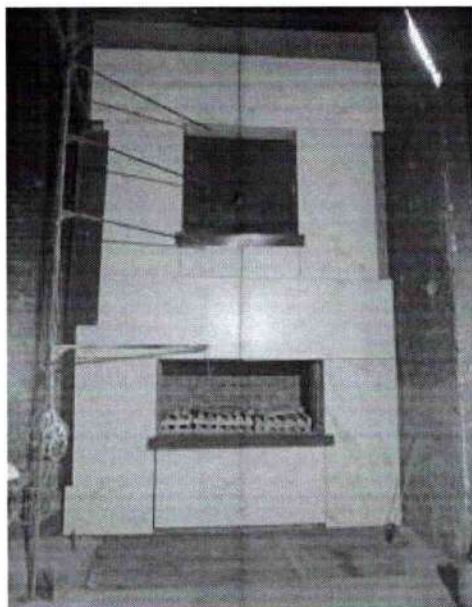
Образец навесного фасада до испытания по ГОСТ 31251-2008.
